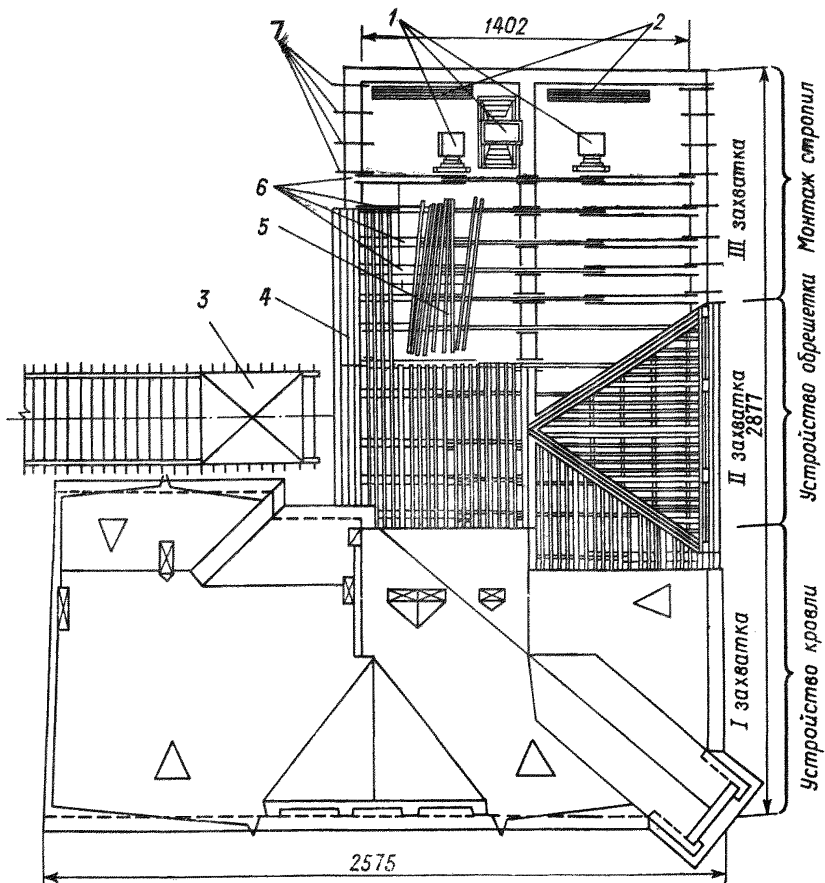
Общая схема организации работ по монтажу дощатых стропил из сборных элементов с обрешеткой из брусков
